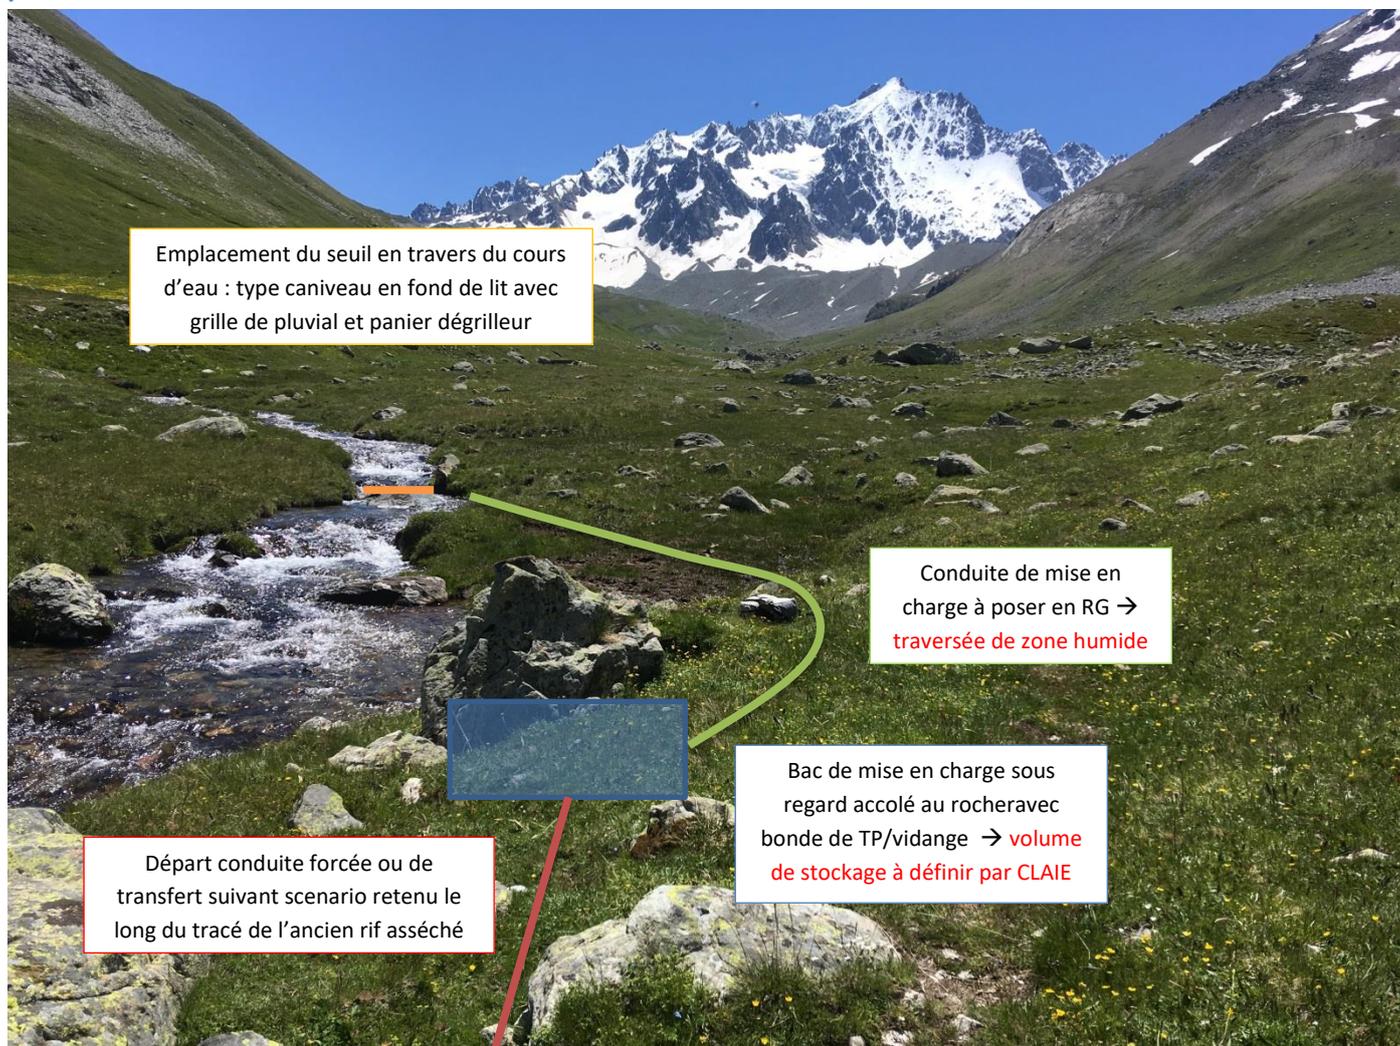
Prise d'eau sur Rif de la Planche (22/06/2020)
